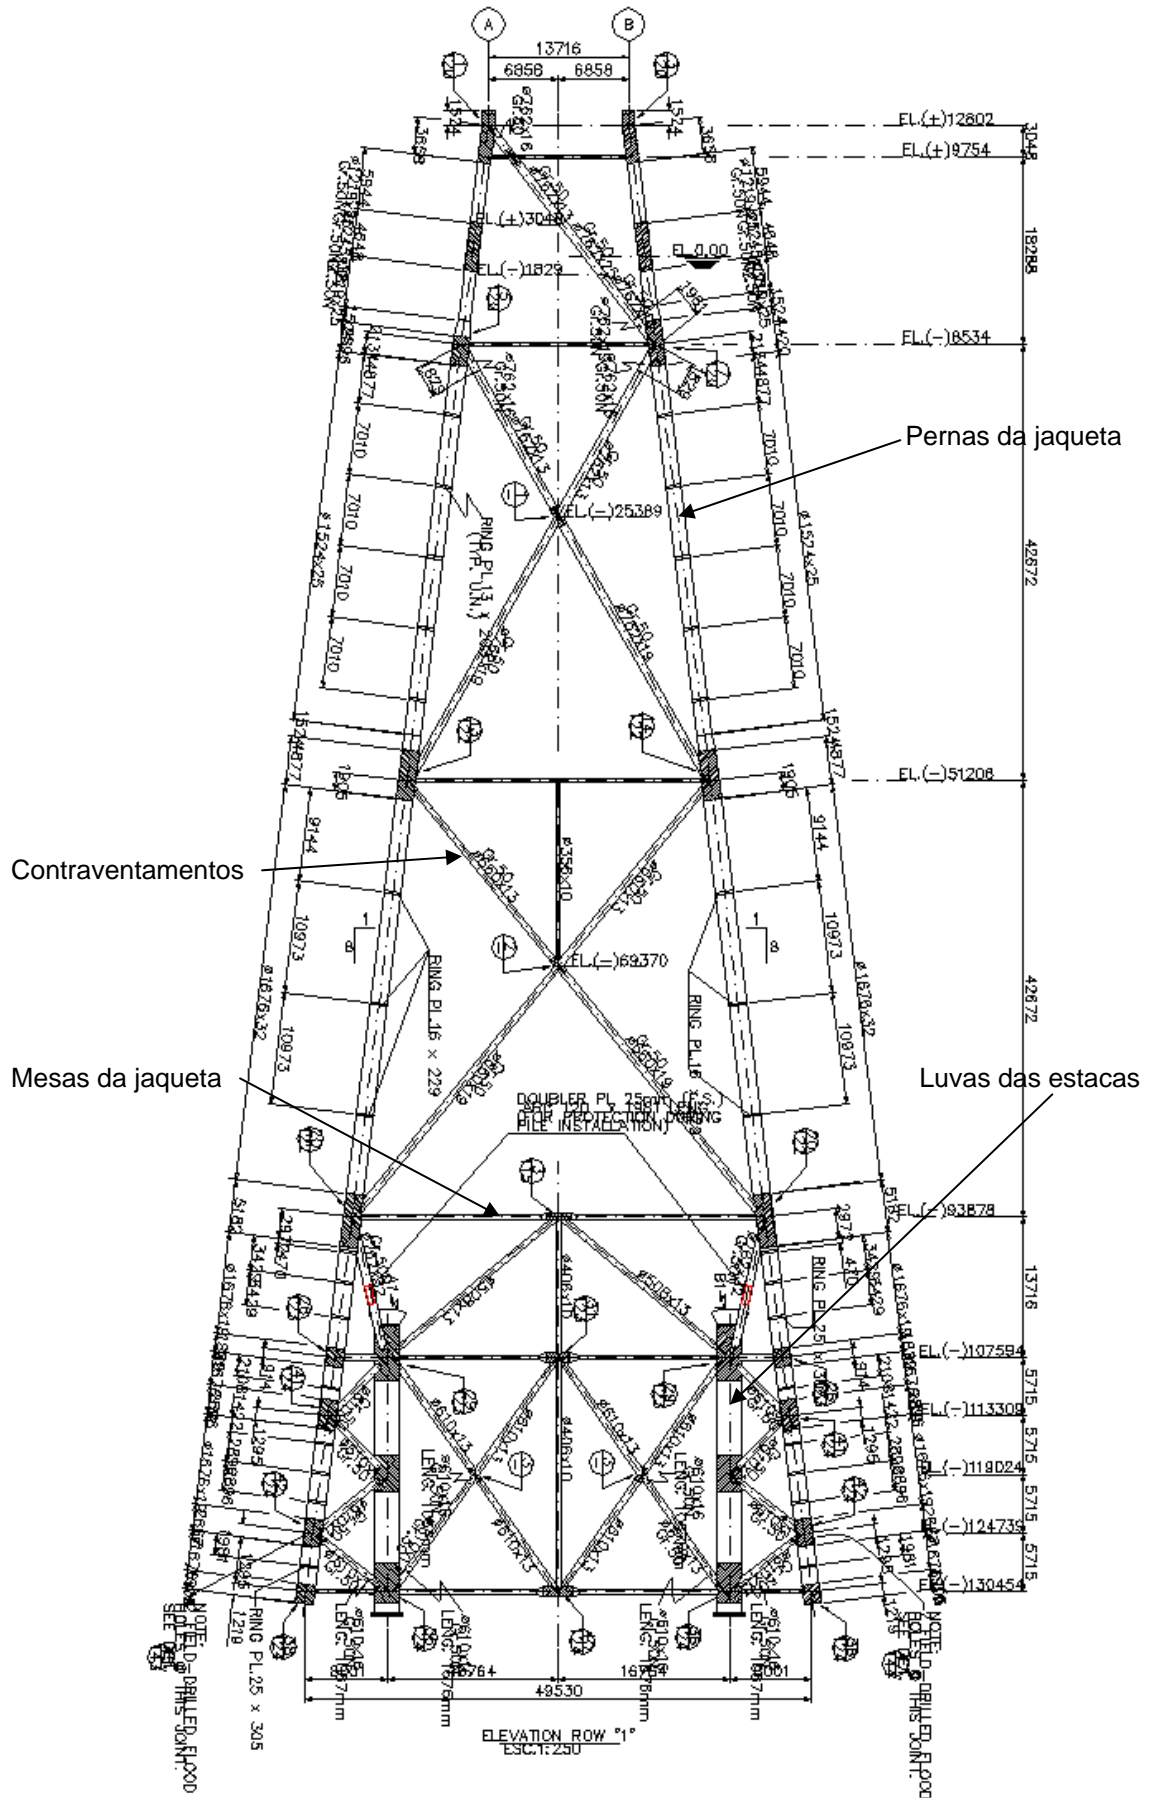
Jaqueta – Elevação do Eixo 1 (cotas em mm)
